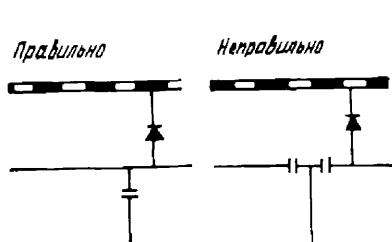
Установка изолирующего фланца на отводе от защищенного трубопровода
